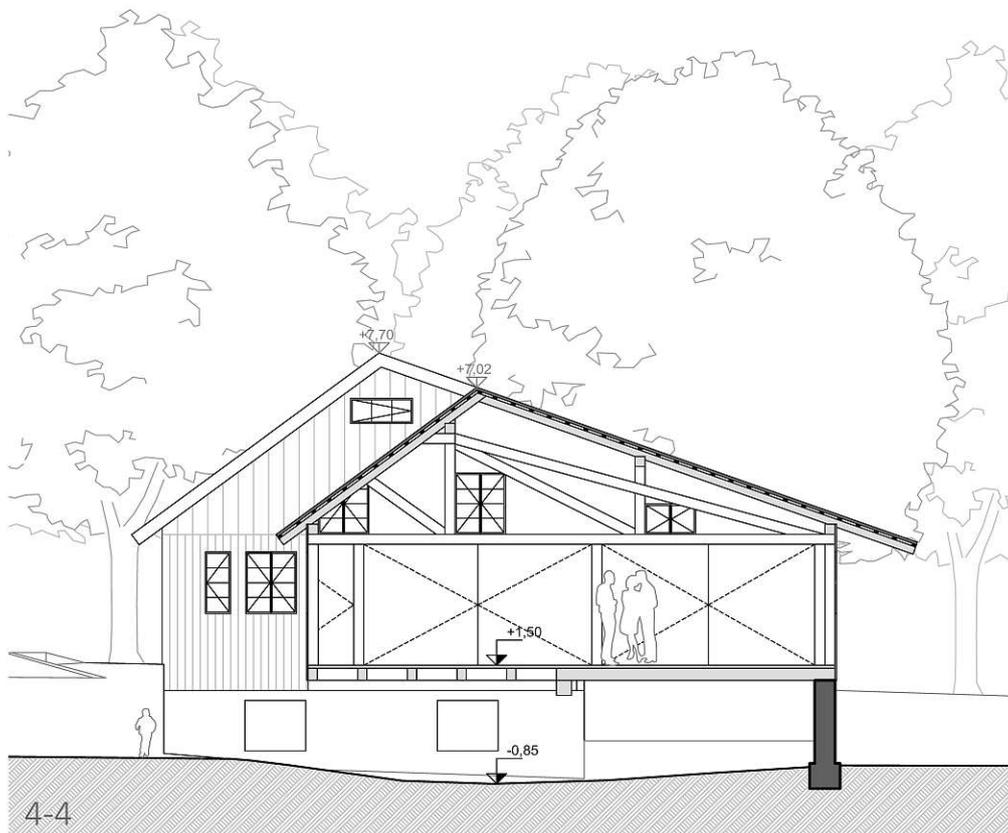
Schnitt Sägwerk 4-4 – Bestand, Maßstab 1:150.
